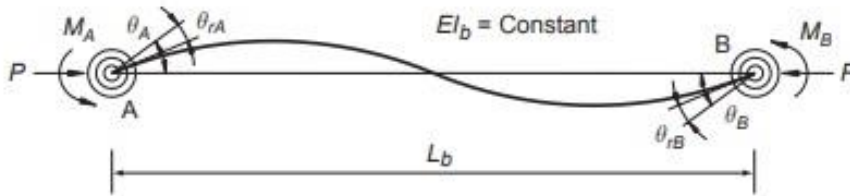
Élément poutre avec assemblage semi rigide [52]
